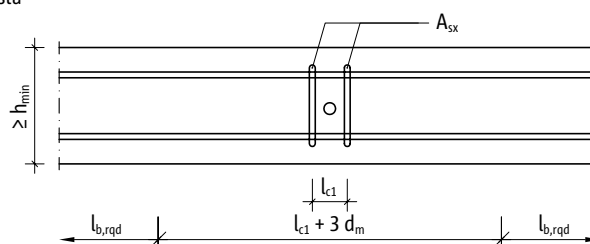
Schöck Dorn tipo LD: armatura in opera
